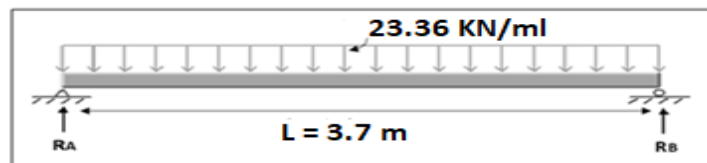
Schéma statique de la poutre palière à l'ELS.
